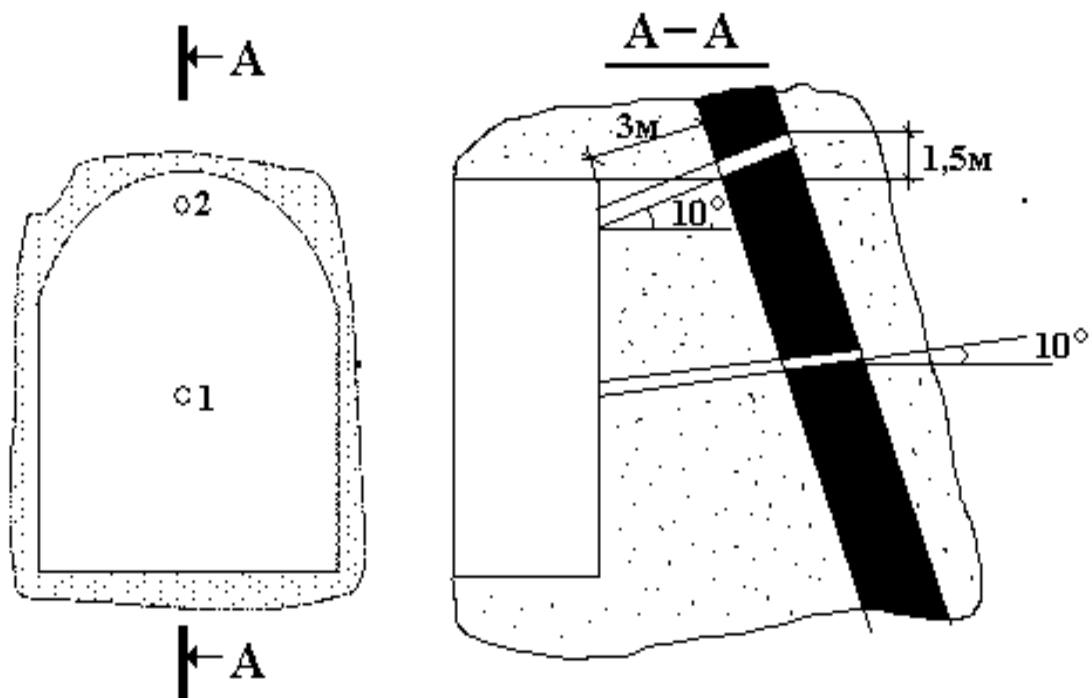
Схема расположения скважин в забое подготовительной выработки при вскрытии крутопадающих угольных пластов
